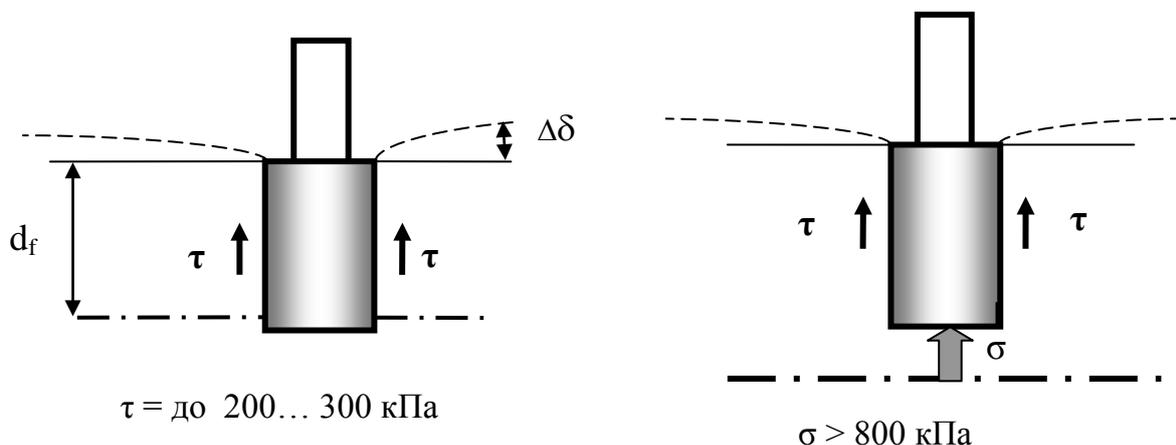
Морозное пучение грунта при различном уровне подземных вод:
